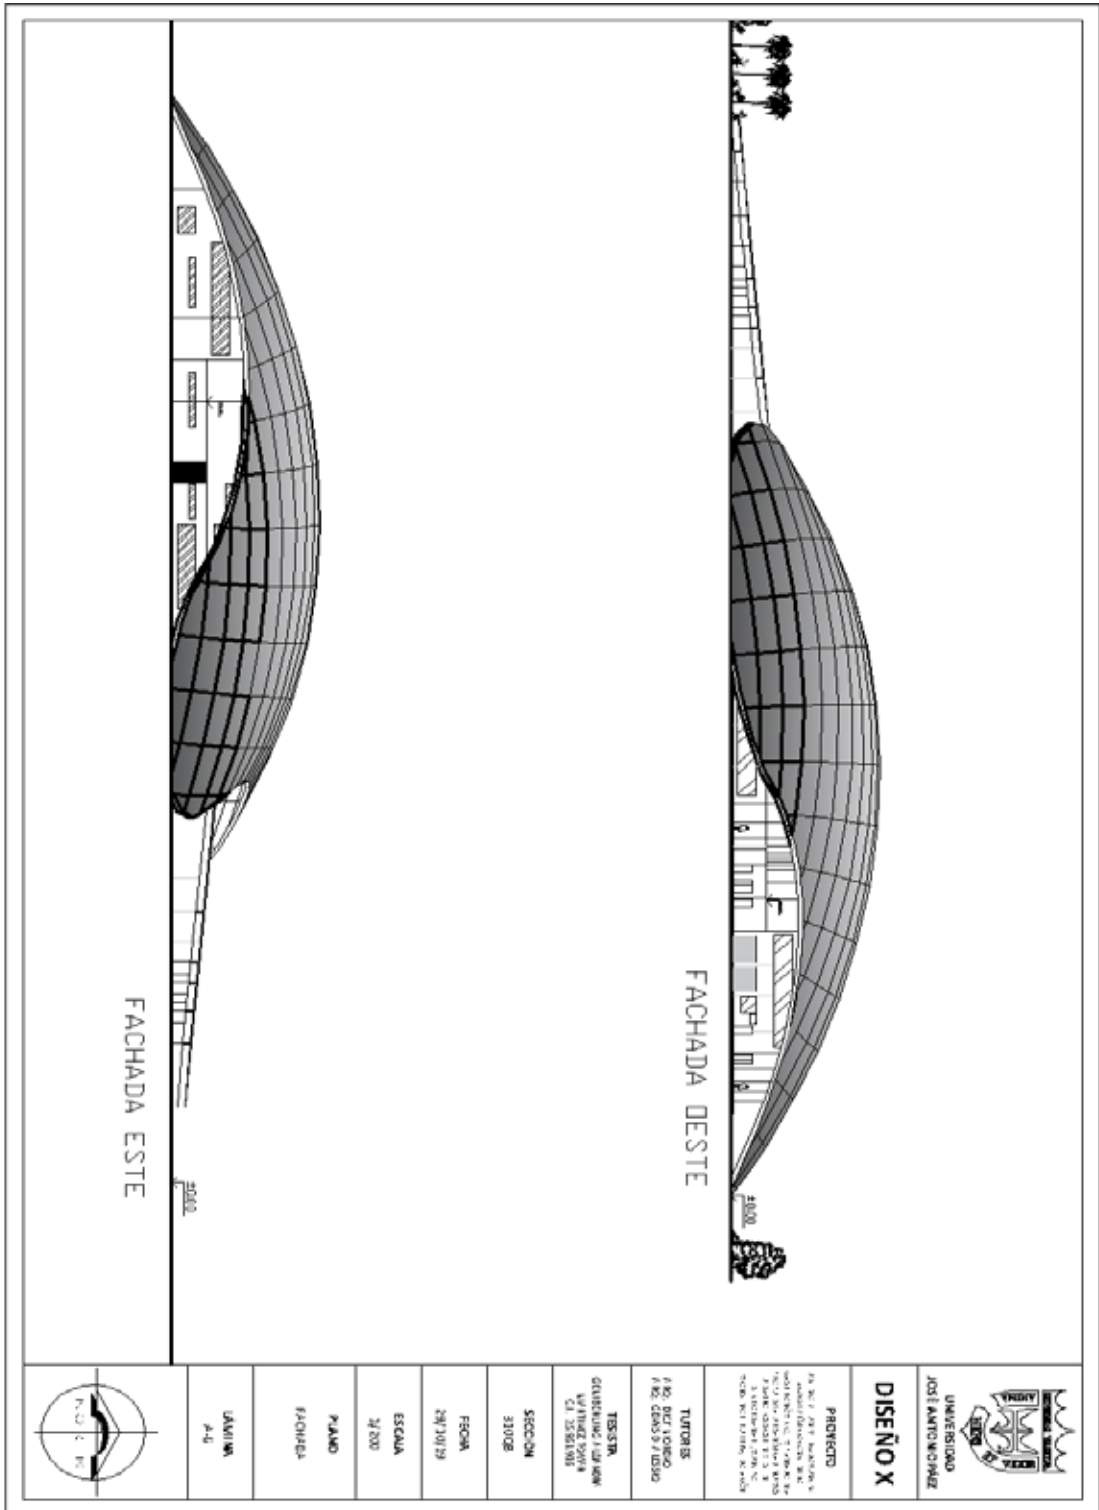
Alzado Este y Oeste. Autor: Gemberling Martínez (2018)
